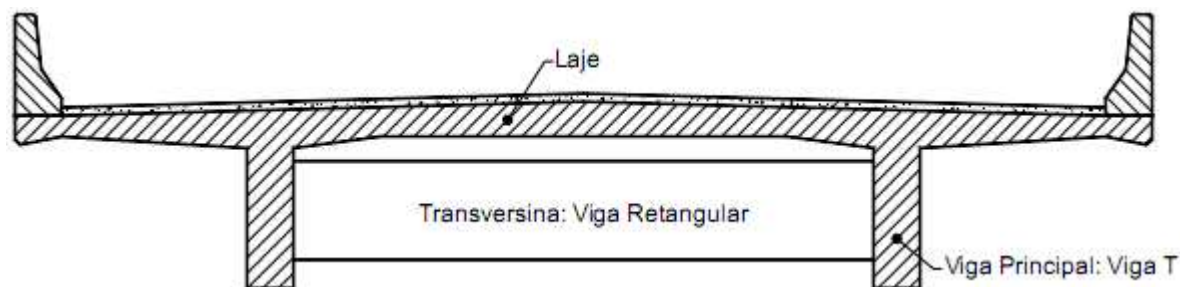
Esquema de uma secção transversal de um tabuleiro vigado
